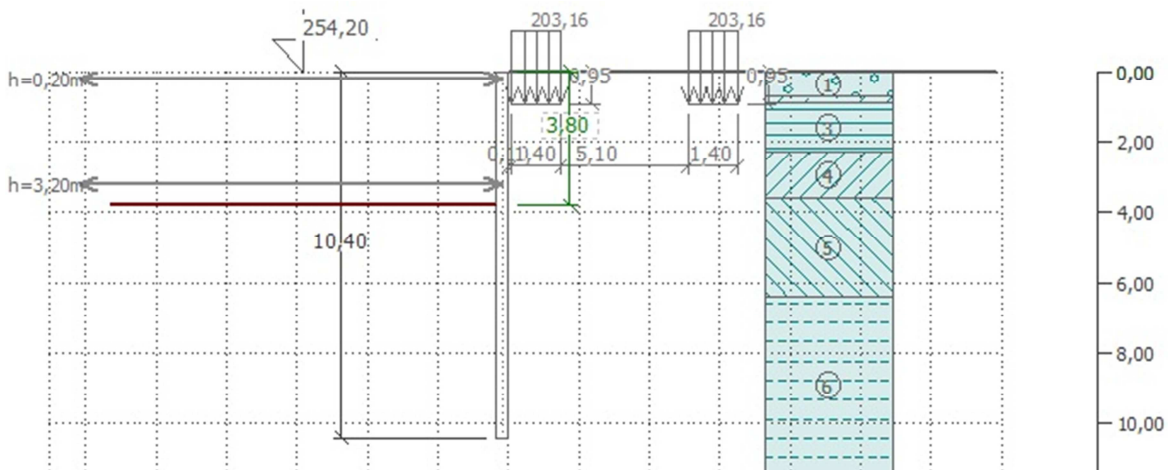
Schéma konstrukce pilotové stěny fáze 2 (zdroj: autor)
